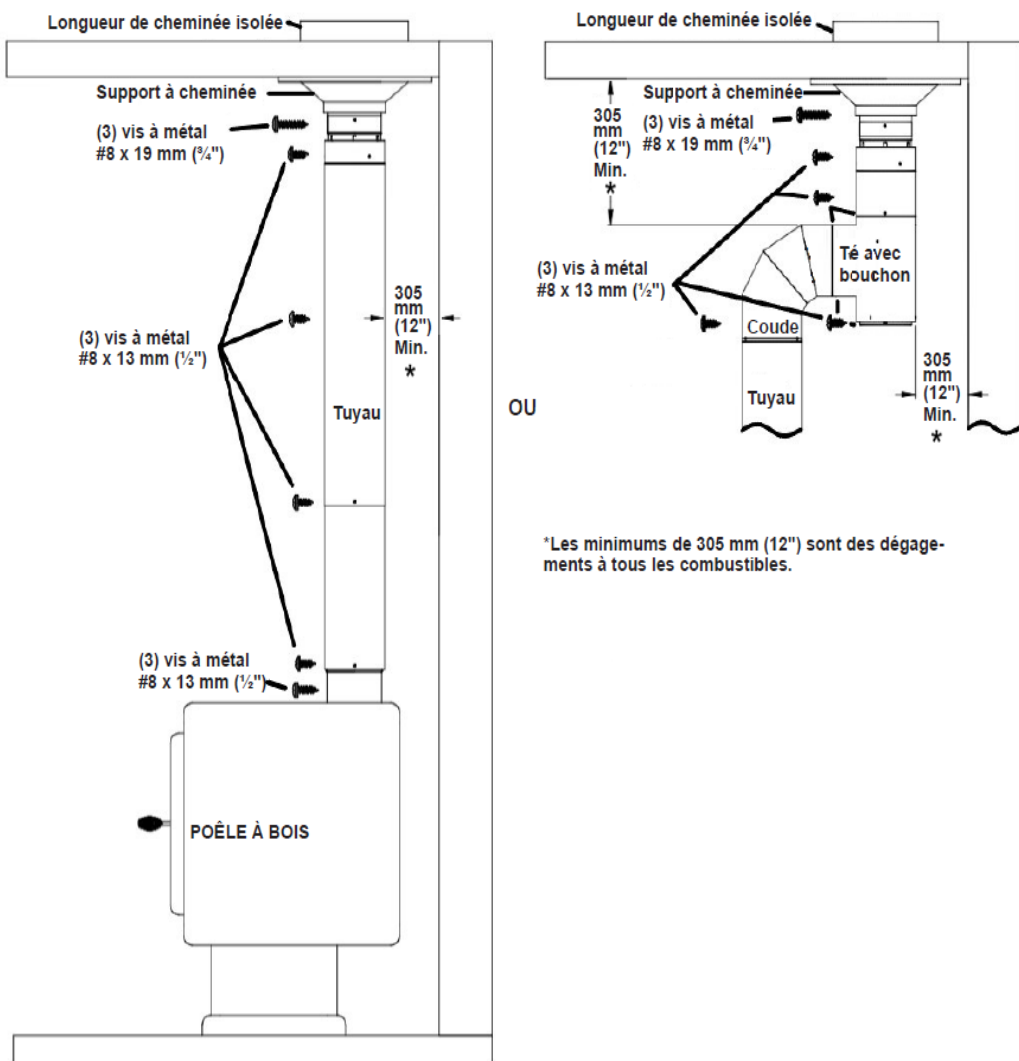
Installation d'un connecteur de cheminée à double paroi sur une cheminée isolée verticale
